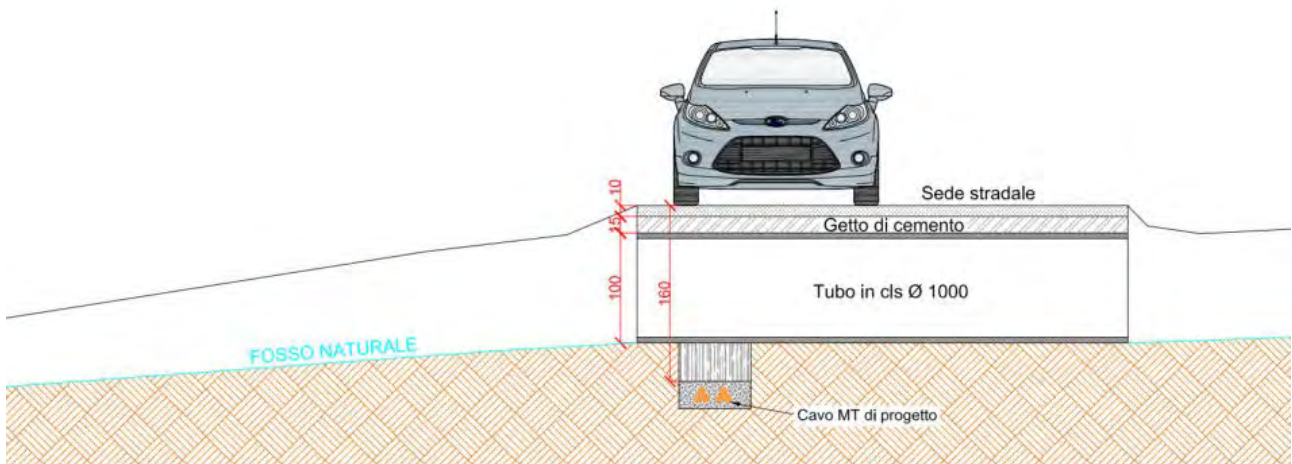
ATTRAVERSAMENTO DI TIPO B - PASSAGGIO DEL CAVIDOTTO AL DI SOTTO DEL TUBO PRESENTE NELL'ATTRAVERSAMENTO
